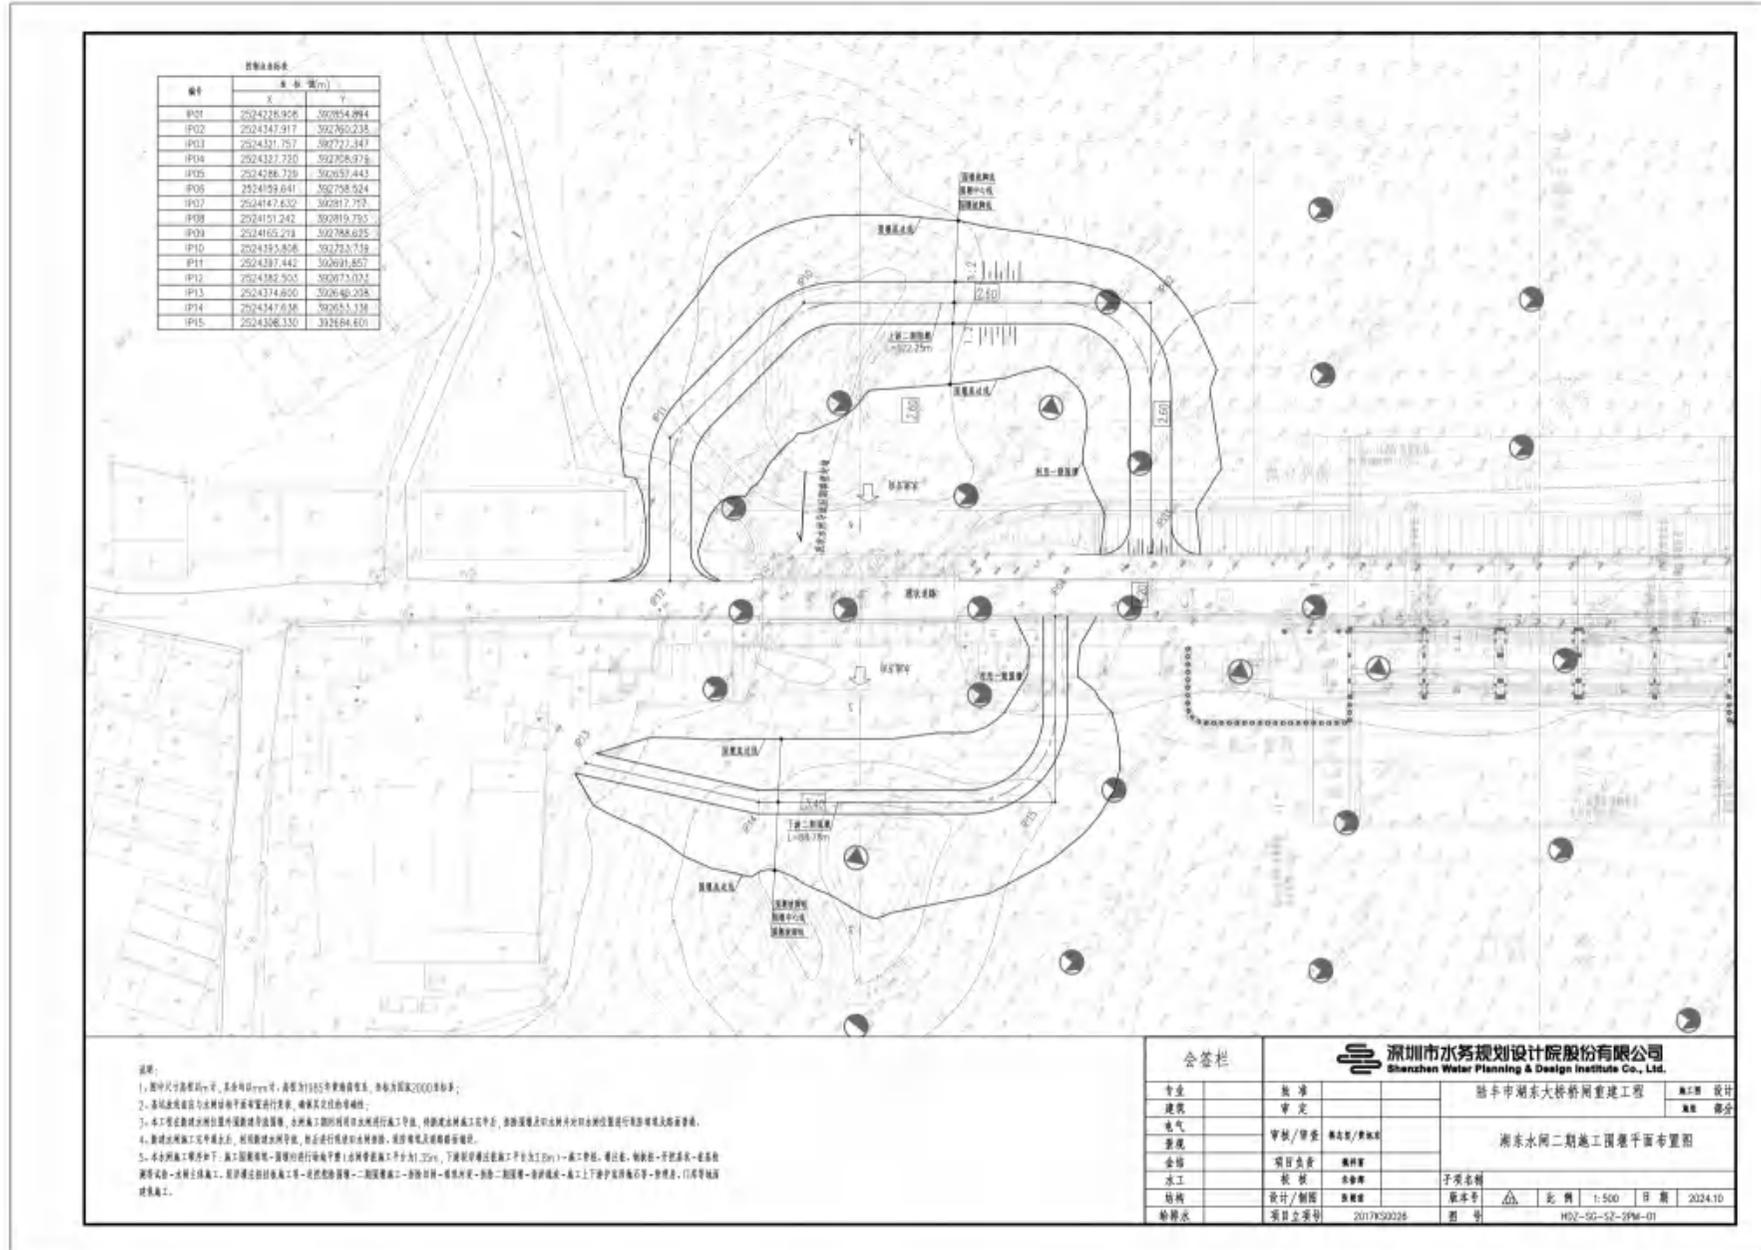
湖东桥闸二期施工围堰平面布置图
